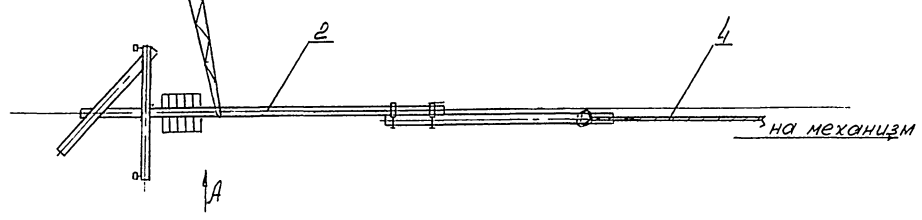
Вариант I. Демонтаж опоры целиком. Строповка опоры и разработка котлована
